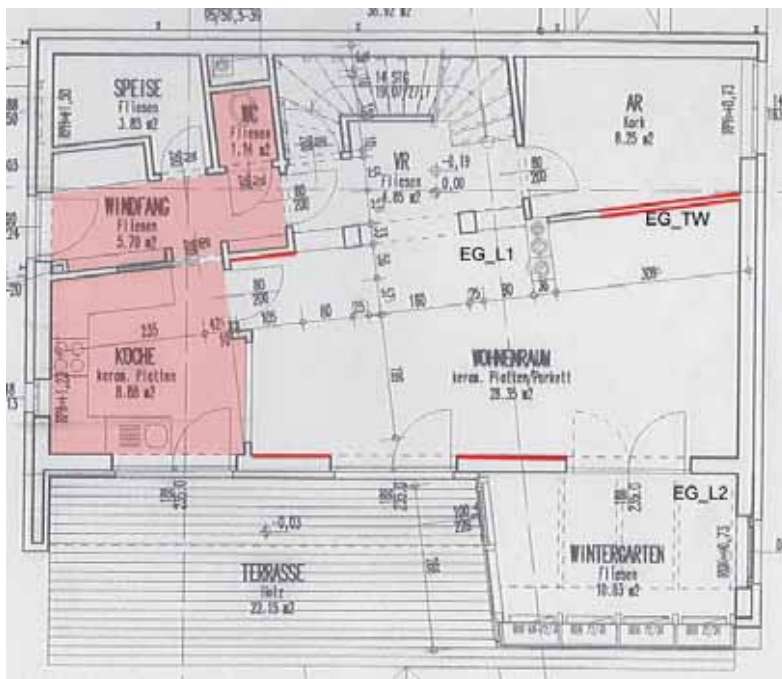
Grundriss Erdgeschoss bei rot markierten Wänden und Fußbodenflächen wurde eine Bauteilaktivierung eingesetzt.
